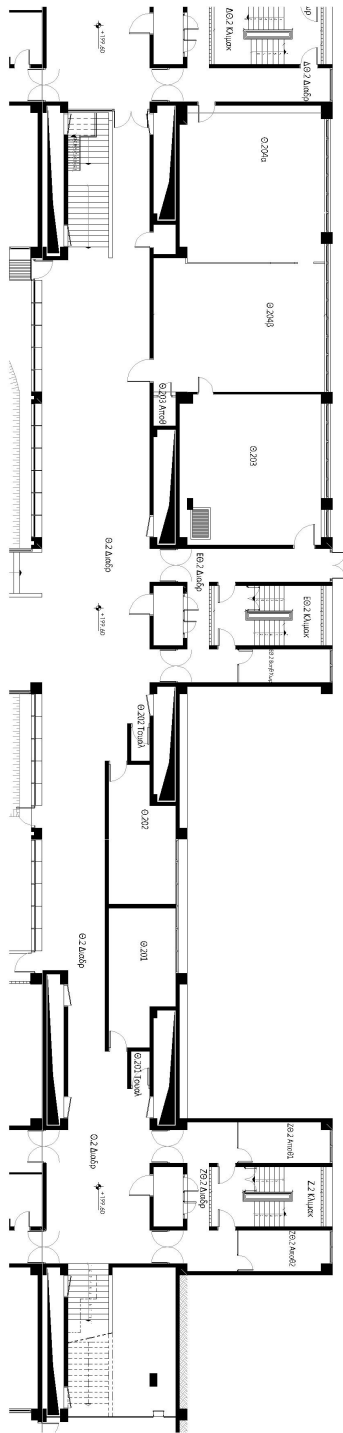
Κάτοψη πτέρυγες Z-ZΘ του επιπέδου 2
